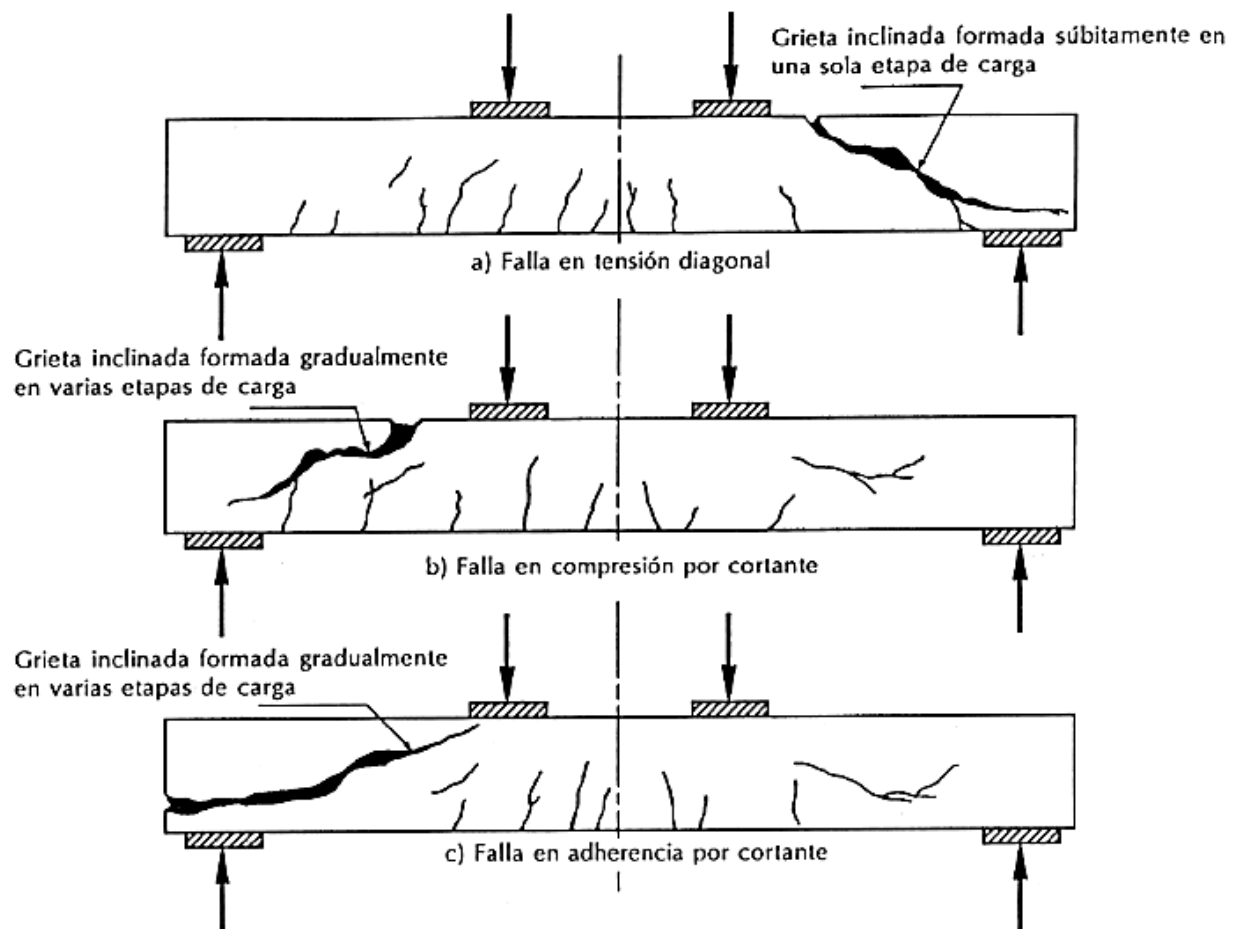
b.1-1.1) Esquematzación e imagen de un ensayo de falla por cortante en viga de concreto armado
